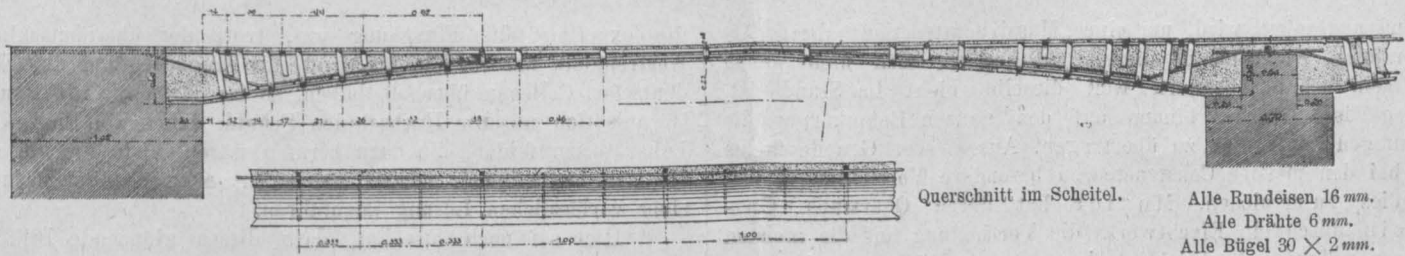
Decke des Kleinen Palastes der schönen Künste.
